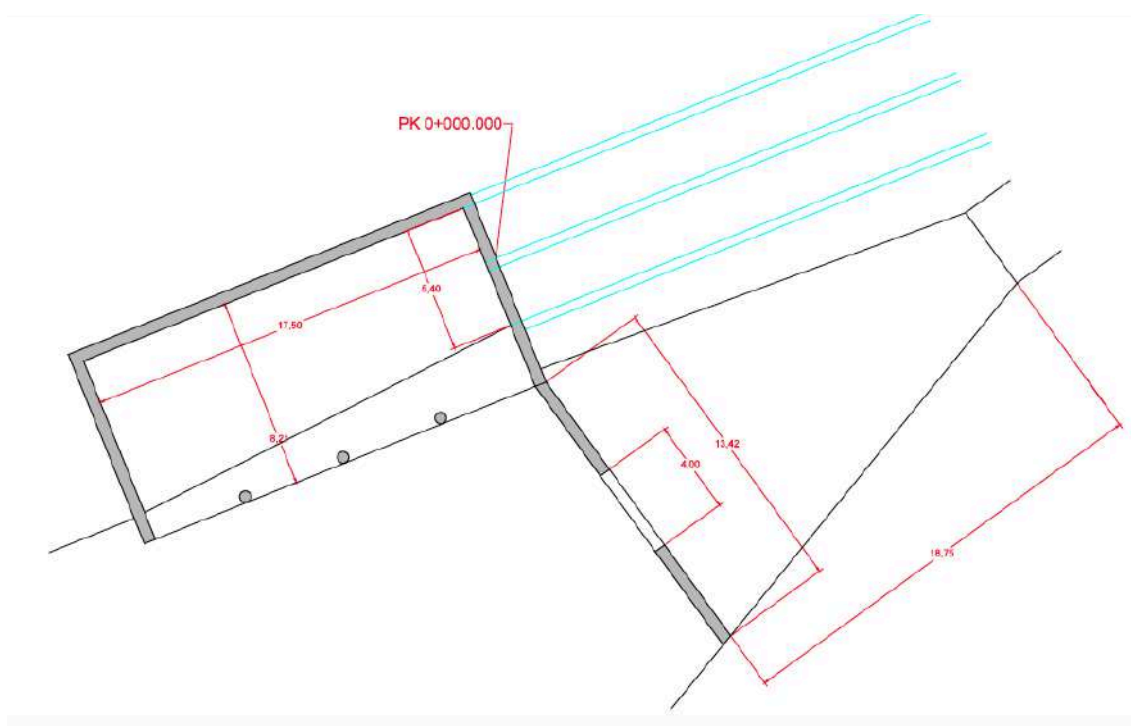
Planta de las embocaduras (cotas en metros). FUENTE: Elaboración propia.
